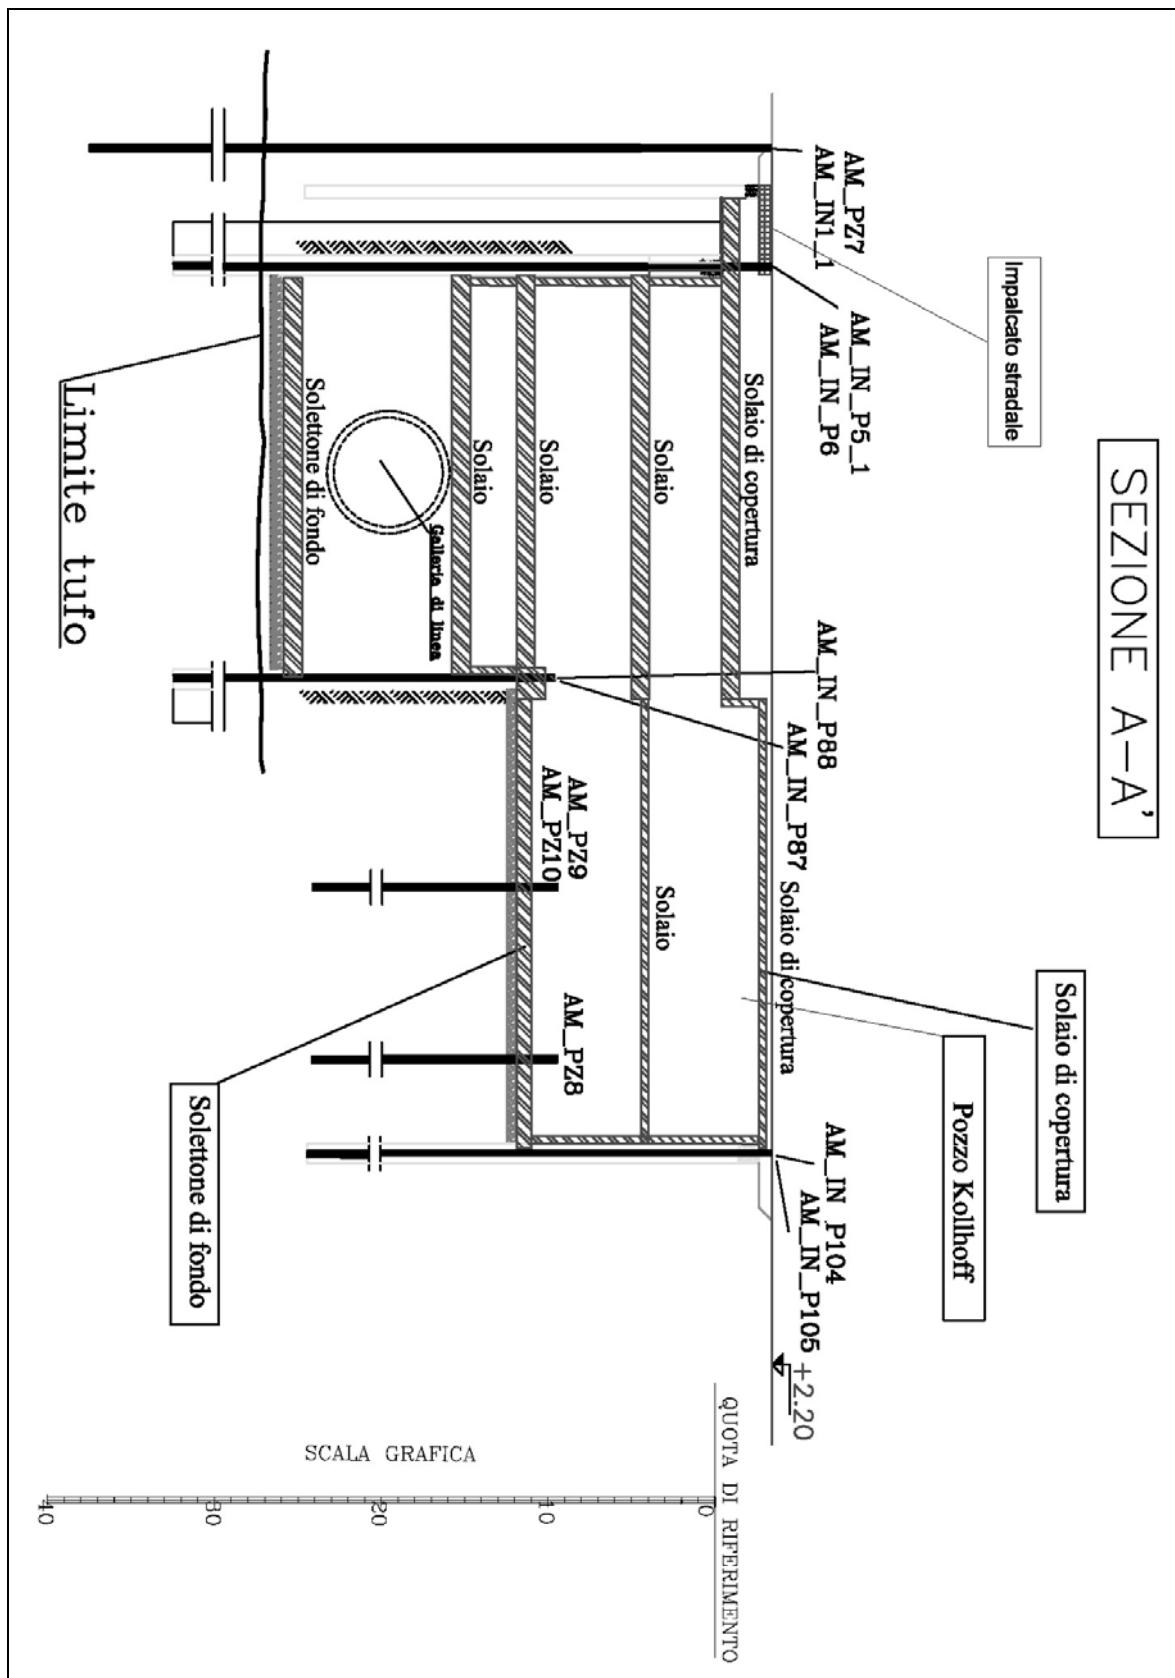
Sezione A-A' pozzo stazione, raffigurante la suddivisione in aree di lavoro.
